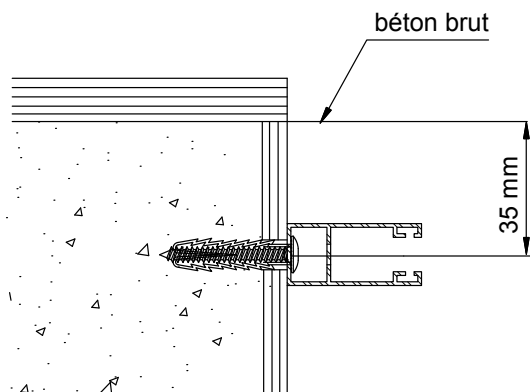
Distance minimale de la fixation par rapport au bord en béton (cas des chevilles nylon)
